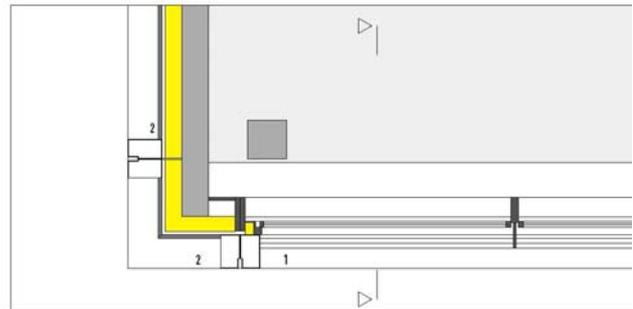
Fassadendetails Wolfsburg Altbau M 1:50
